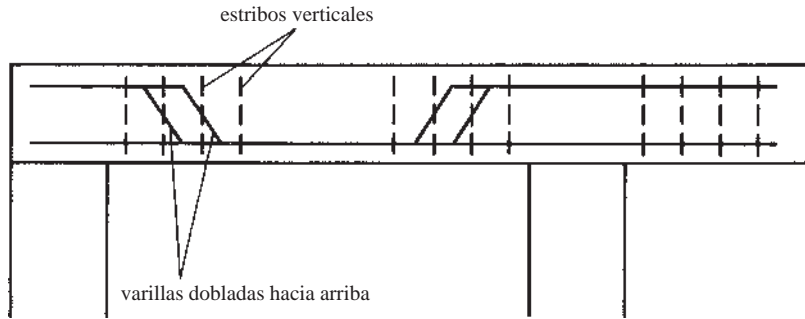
Refuerzo de alma con varillas dobladas hacia arriba.
